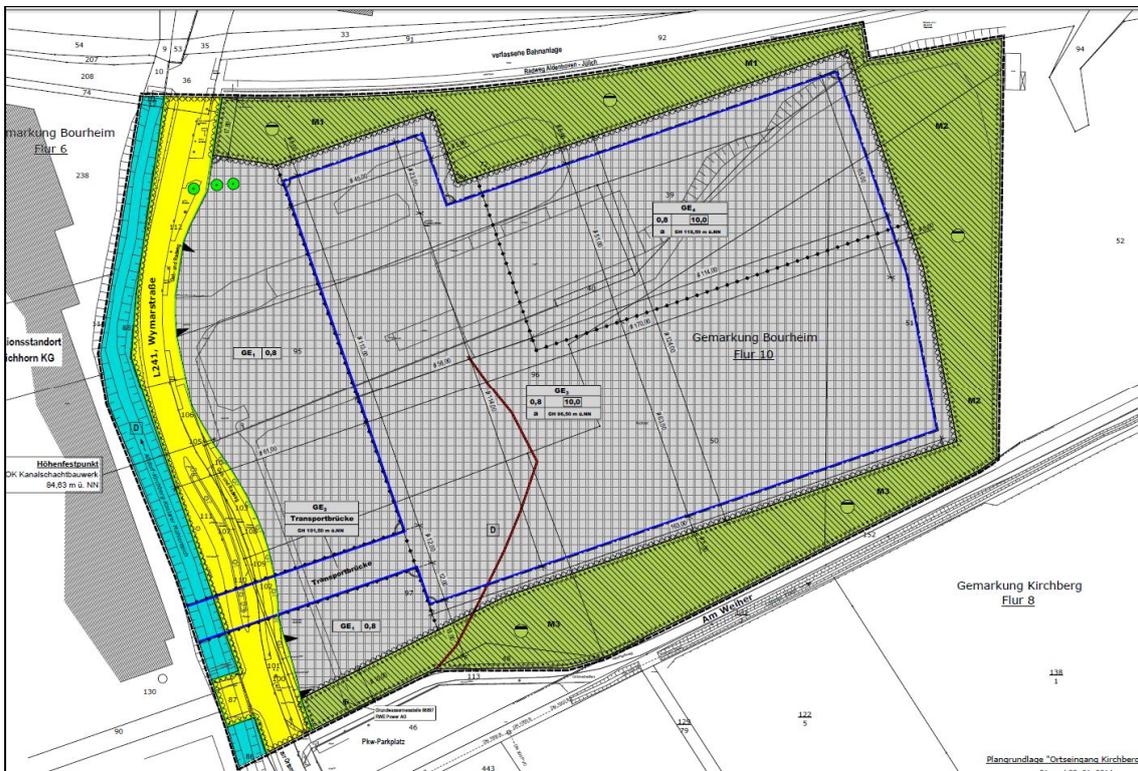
Der Bebauungsplan mit seinen Festsetzungen.
